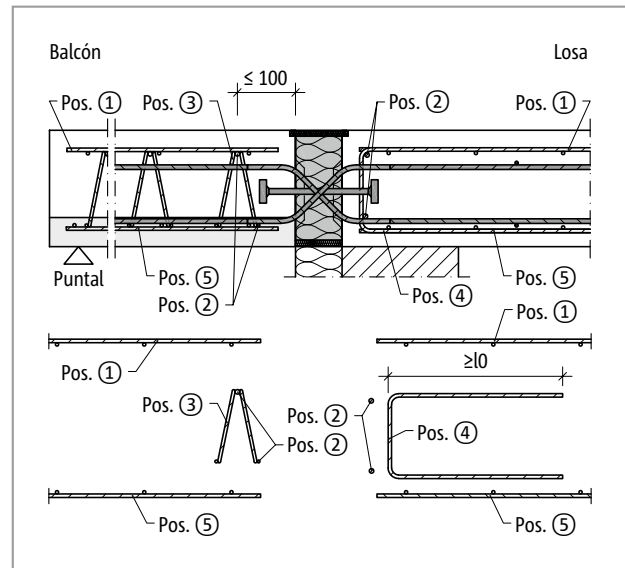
Schöck Isokorb® T tipo Q-P-VV: Armadura in situ, del lado del balcón con viga de celosía
